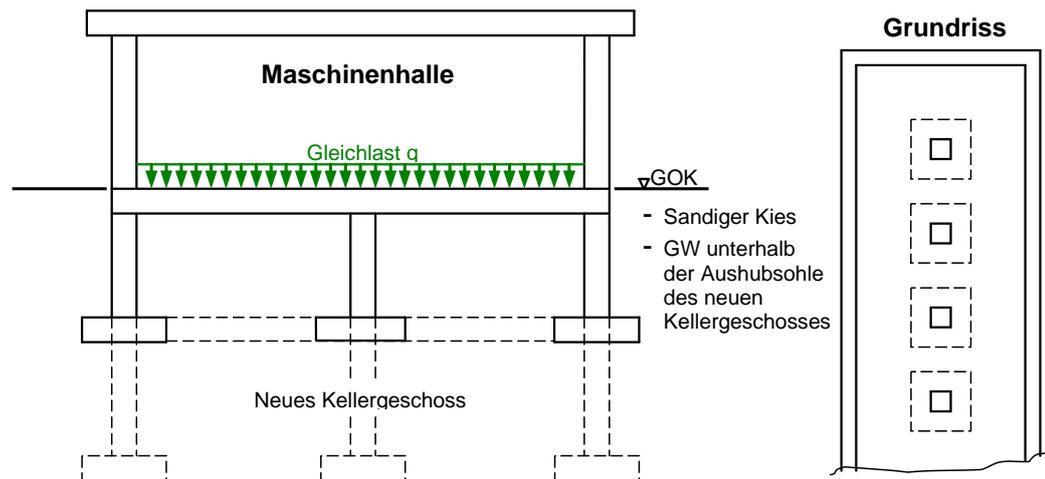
Maschinenhalle Schnitt und Grundriss
